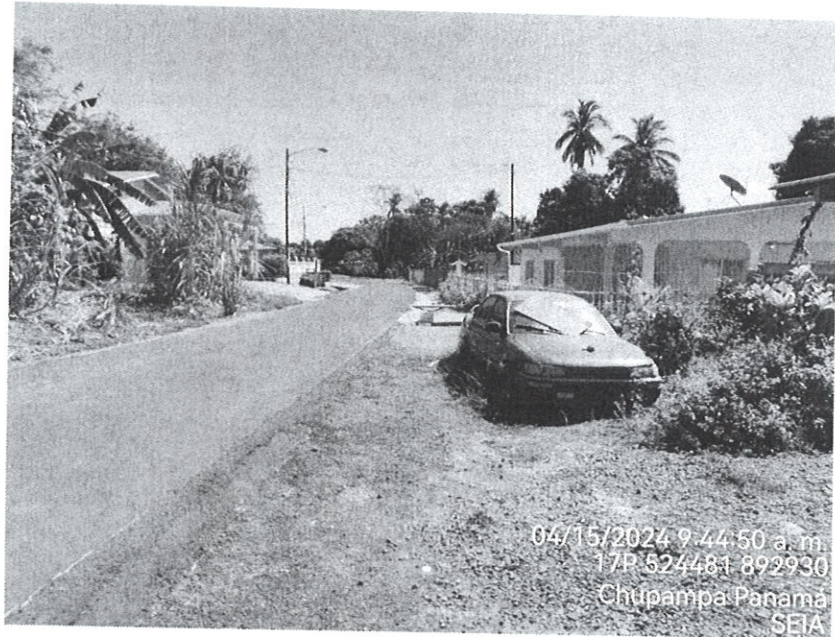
Se observa planchas de concreto de entrada a las viviendas colindantes a la servidumbre
